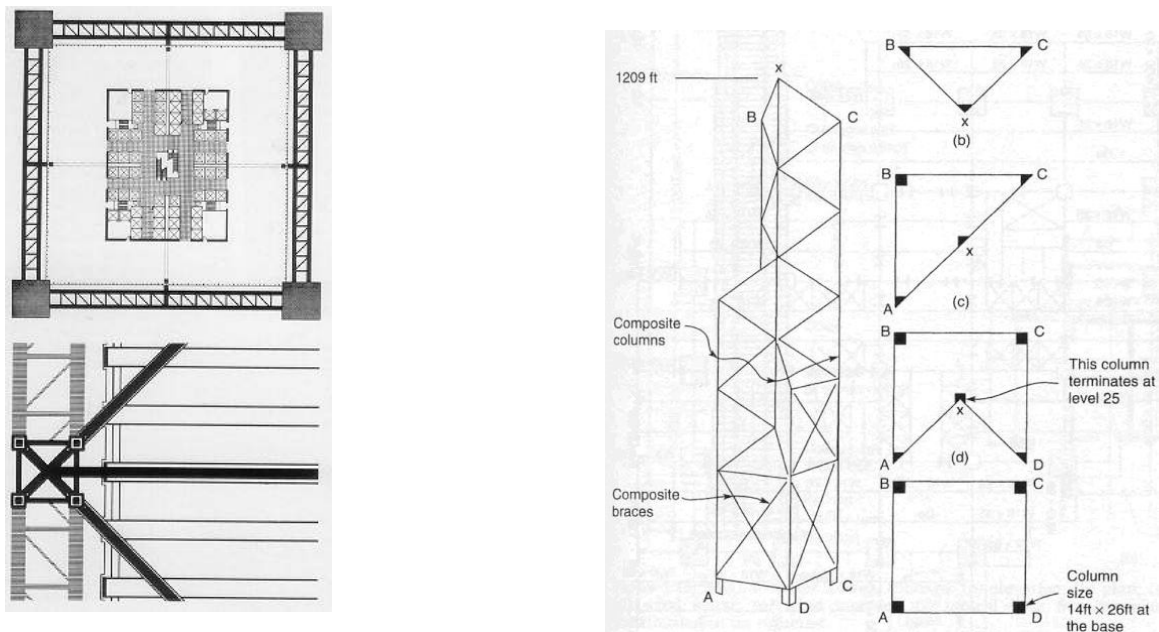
Erehwon Center. Planta y detalle de sección. Banco de China. Esquema estructural.
